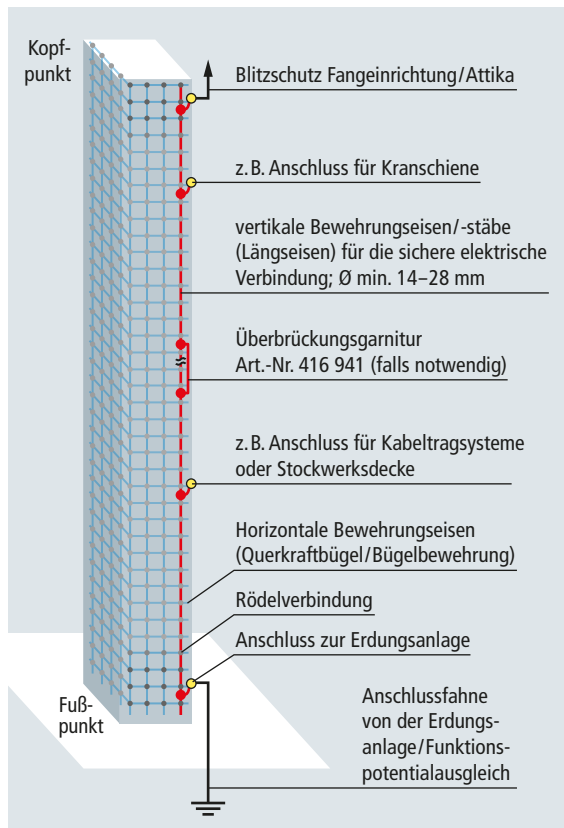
Schematischer Aufbau einer Stahlbetonstütze
